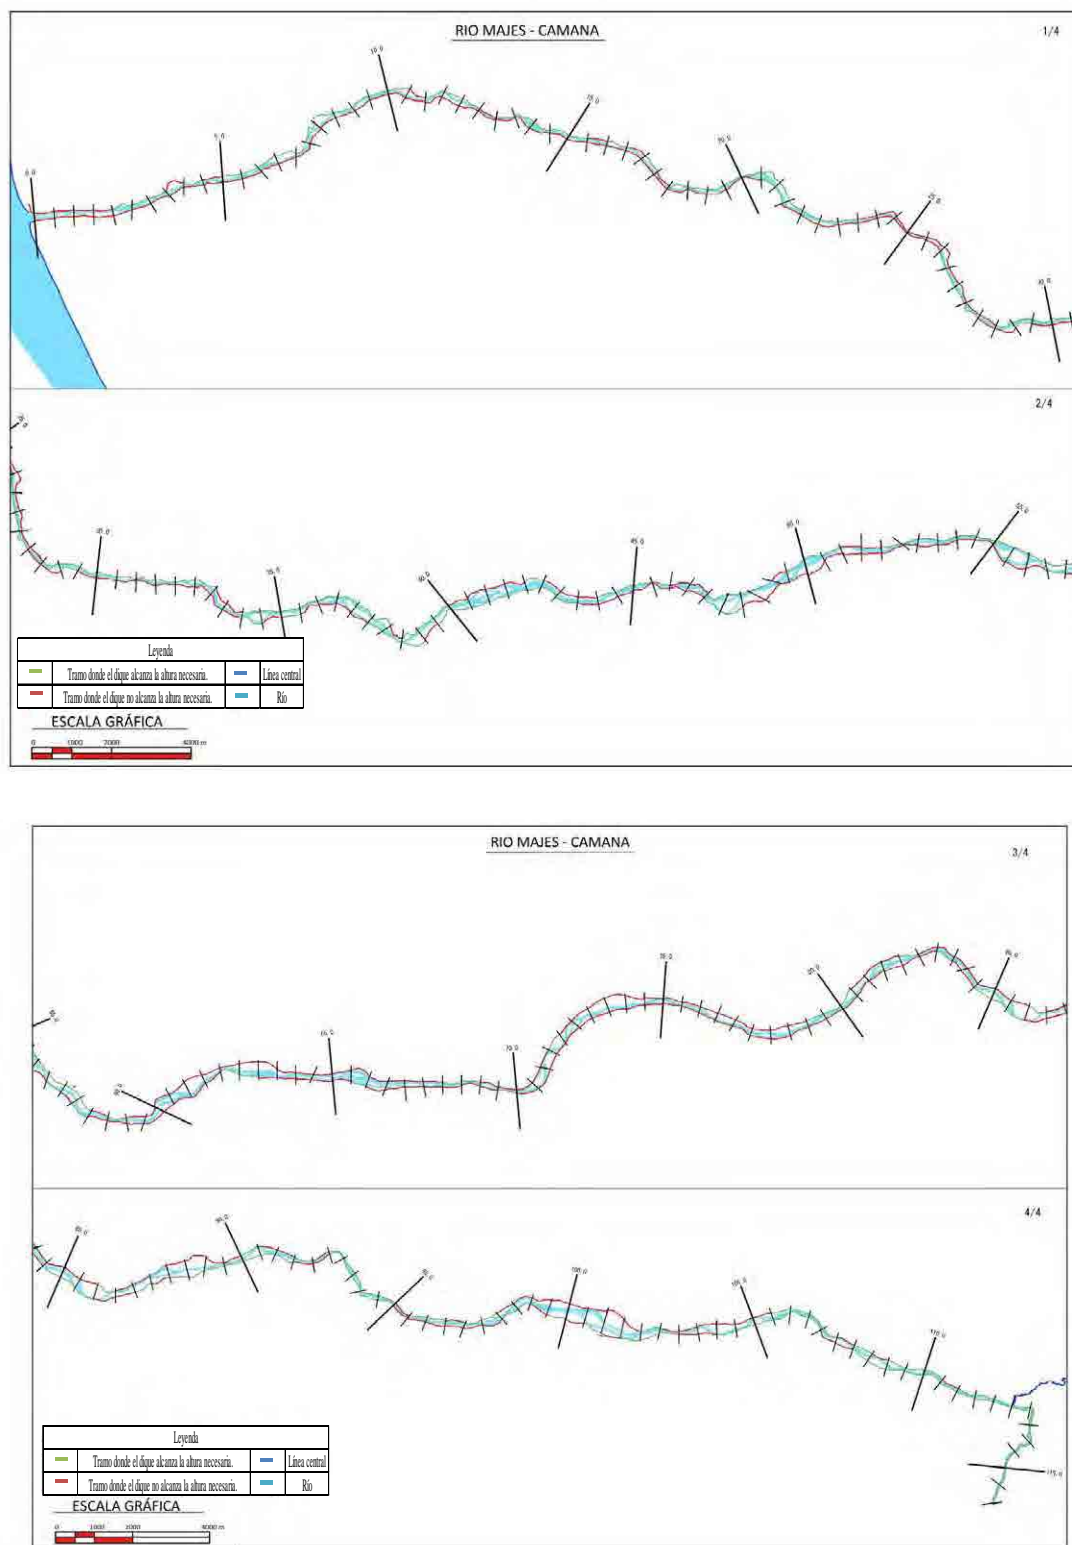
Plano de planta del Río Majes-Camaná
